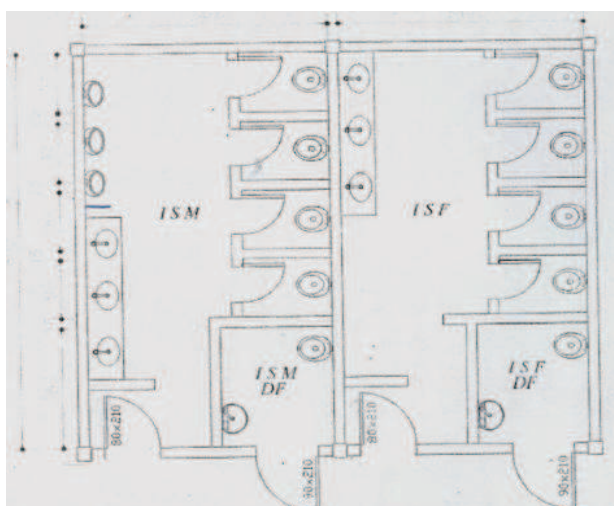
Planta Baixa do Banheiro no Anteprojeto
